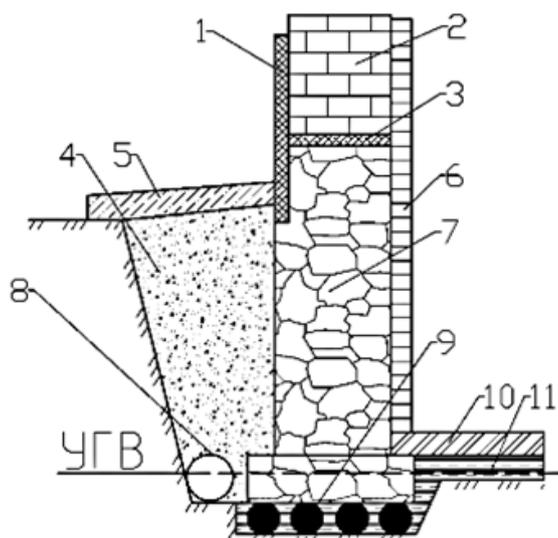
Наиболее распространенный вариант устройства подвала в Санкт-Петербурге в XIX веке: 1 – облицовка цоколя; 2 – кирпичная стена; 3 – горизонтальная гидроизоляция; 4 – засыпка фильтрующим грунтом; 5 – отсыпка; 6 – облицовка кирпичом; 7 – бутовая кладка; 8 – дренажная труба; 9 – дренажные лежни в глине; 10 – каменный или кирпичный пол подвала; 11 – трамбованная глина [20]
